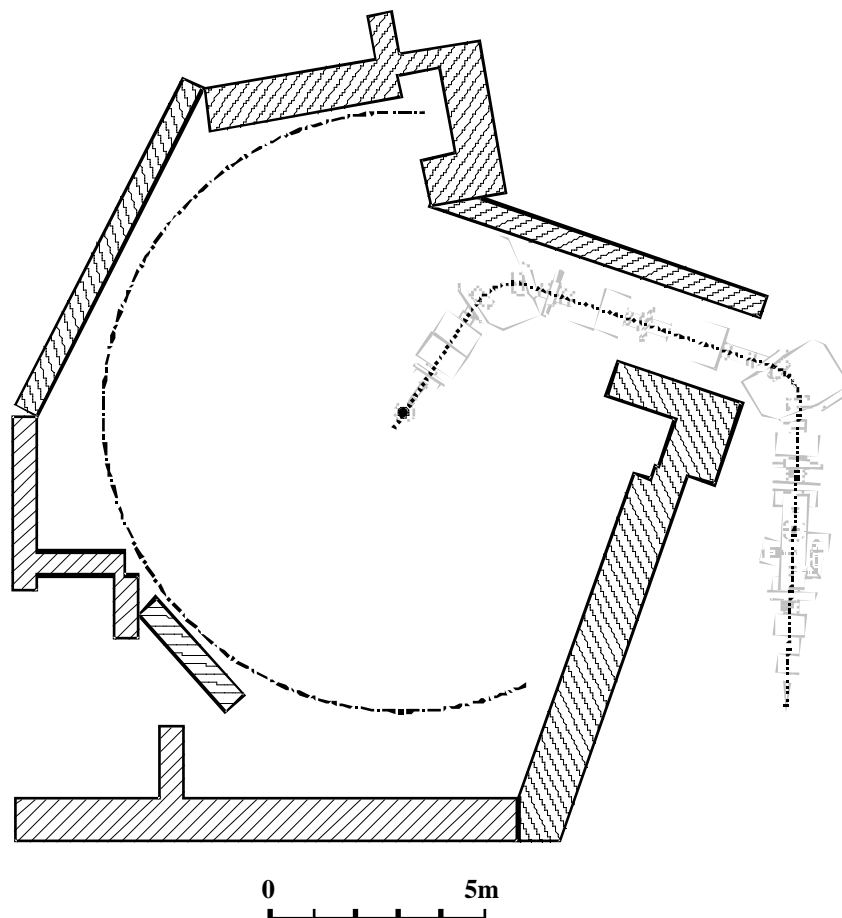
Grundriss des π M1 Areal
